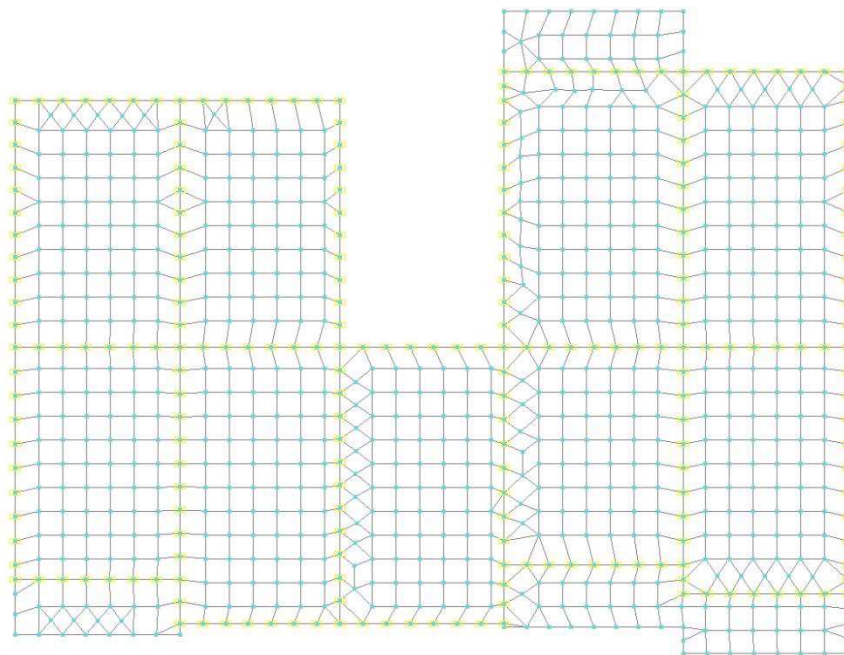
Расчетная схема плиты перекрытия в плоскости.
